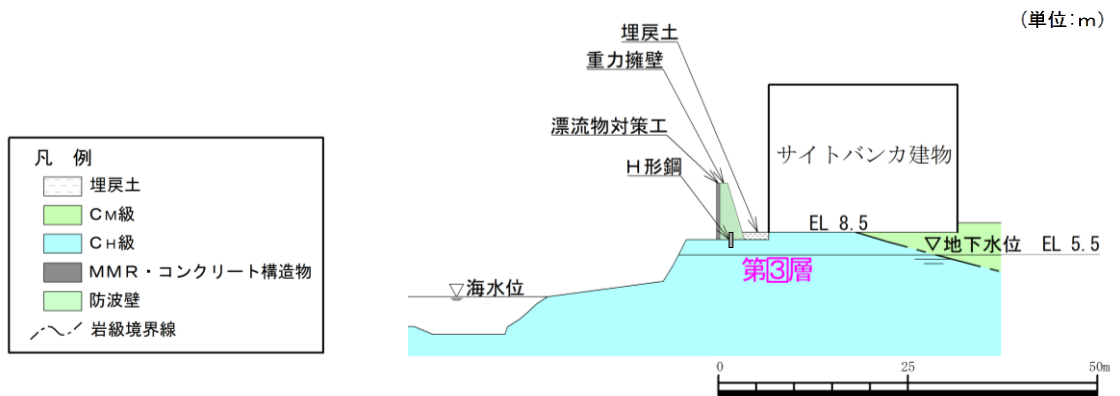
地質断面図 (⑤-⑤断面)
